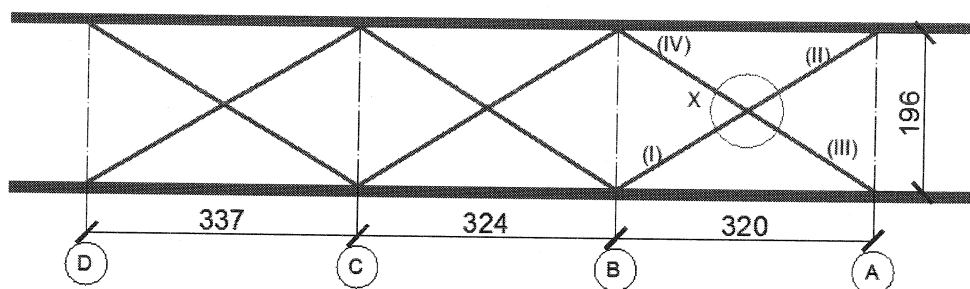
Rzut stalowej konstrukcji dachowej zadaszenia auli
